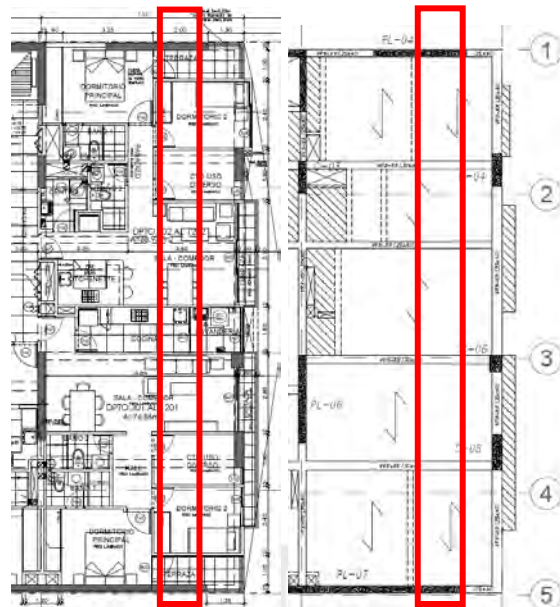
Vigüeta seleccionada para el metrado de losa aligerada
